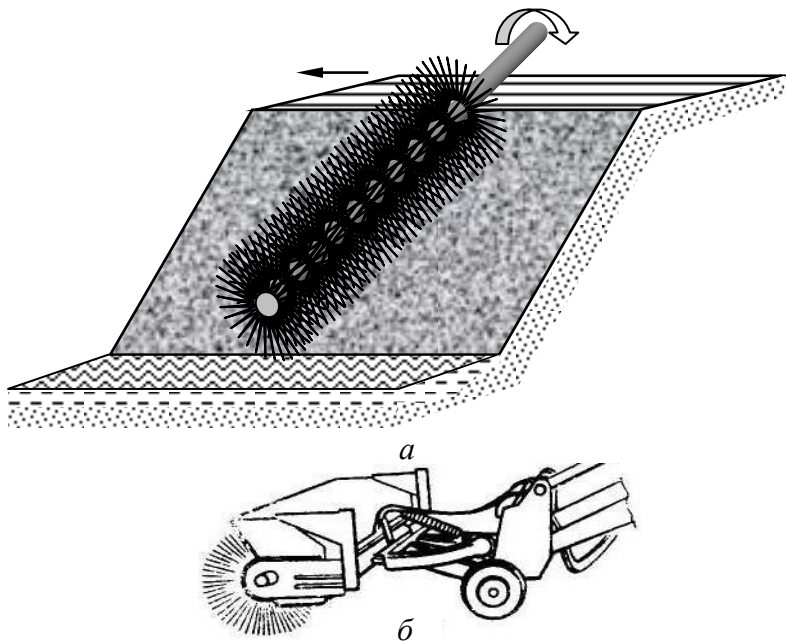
Схема щетки-фрезы с осью вращения, параллельной обрабатываемой поверхности: а – положение щетки на откосе канала; б – схема рабочего органа.
